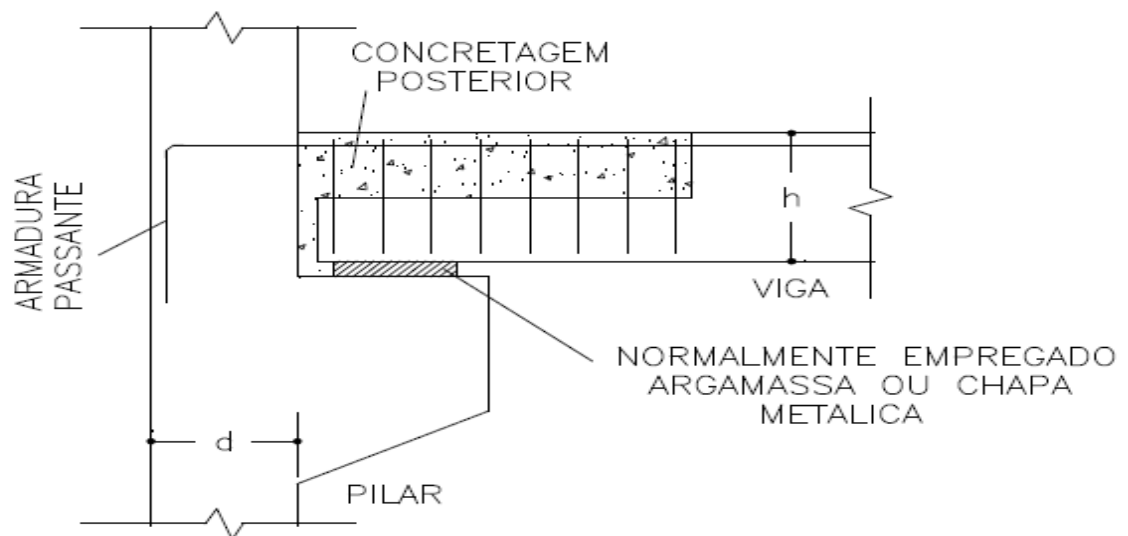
Ligação Rígida Pilar-Viga de Topo.
